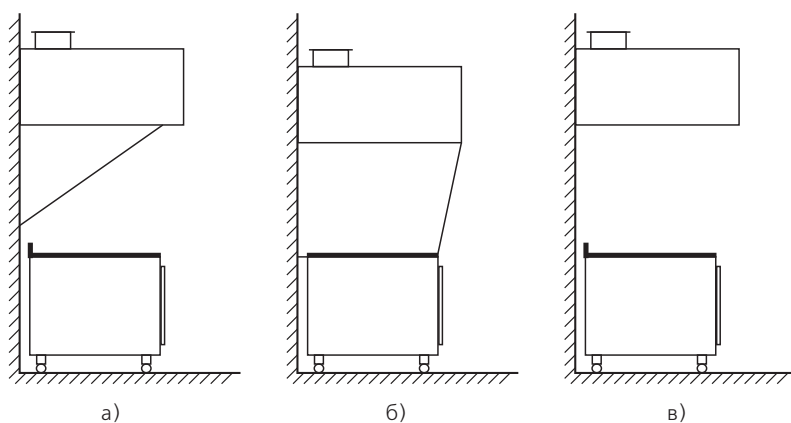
Пример установки кухонного оборудования с боковыми панелями и без них: а) с треугольными боковыми панелями; б) с периферийными боковыми панелями; в) без боковых панелей
